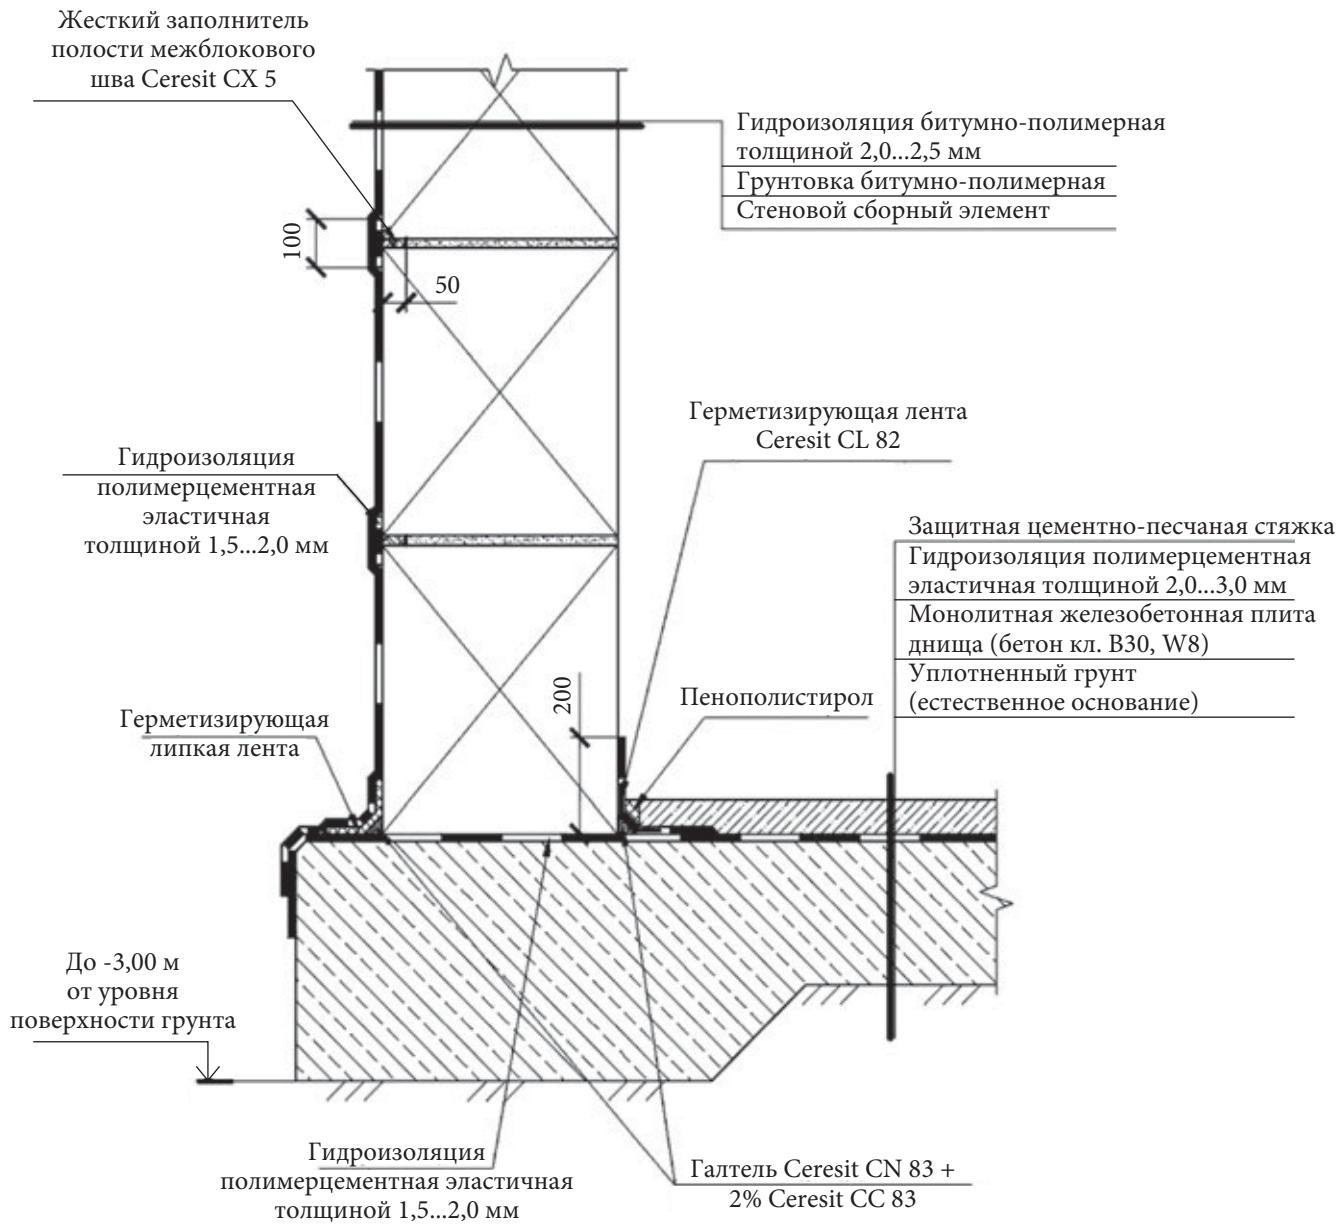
Гидроизоляция бетонных плит оснований и стен подземных сооружений в условиях воздействия грунтовой влаги
